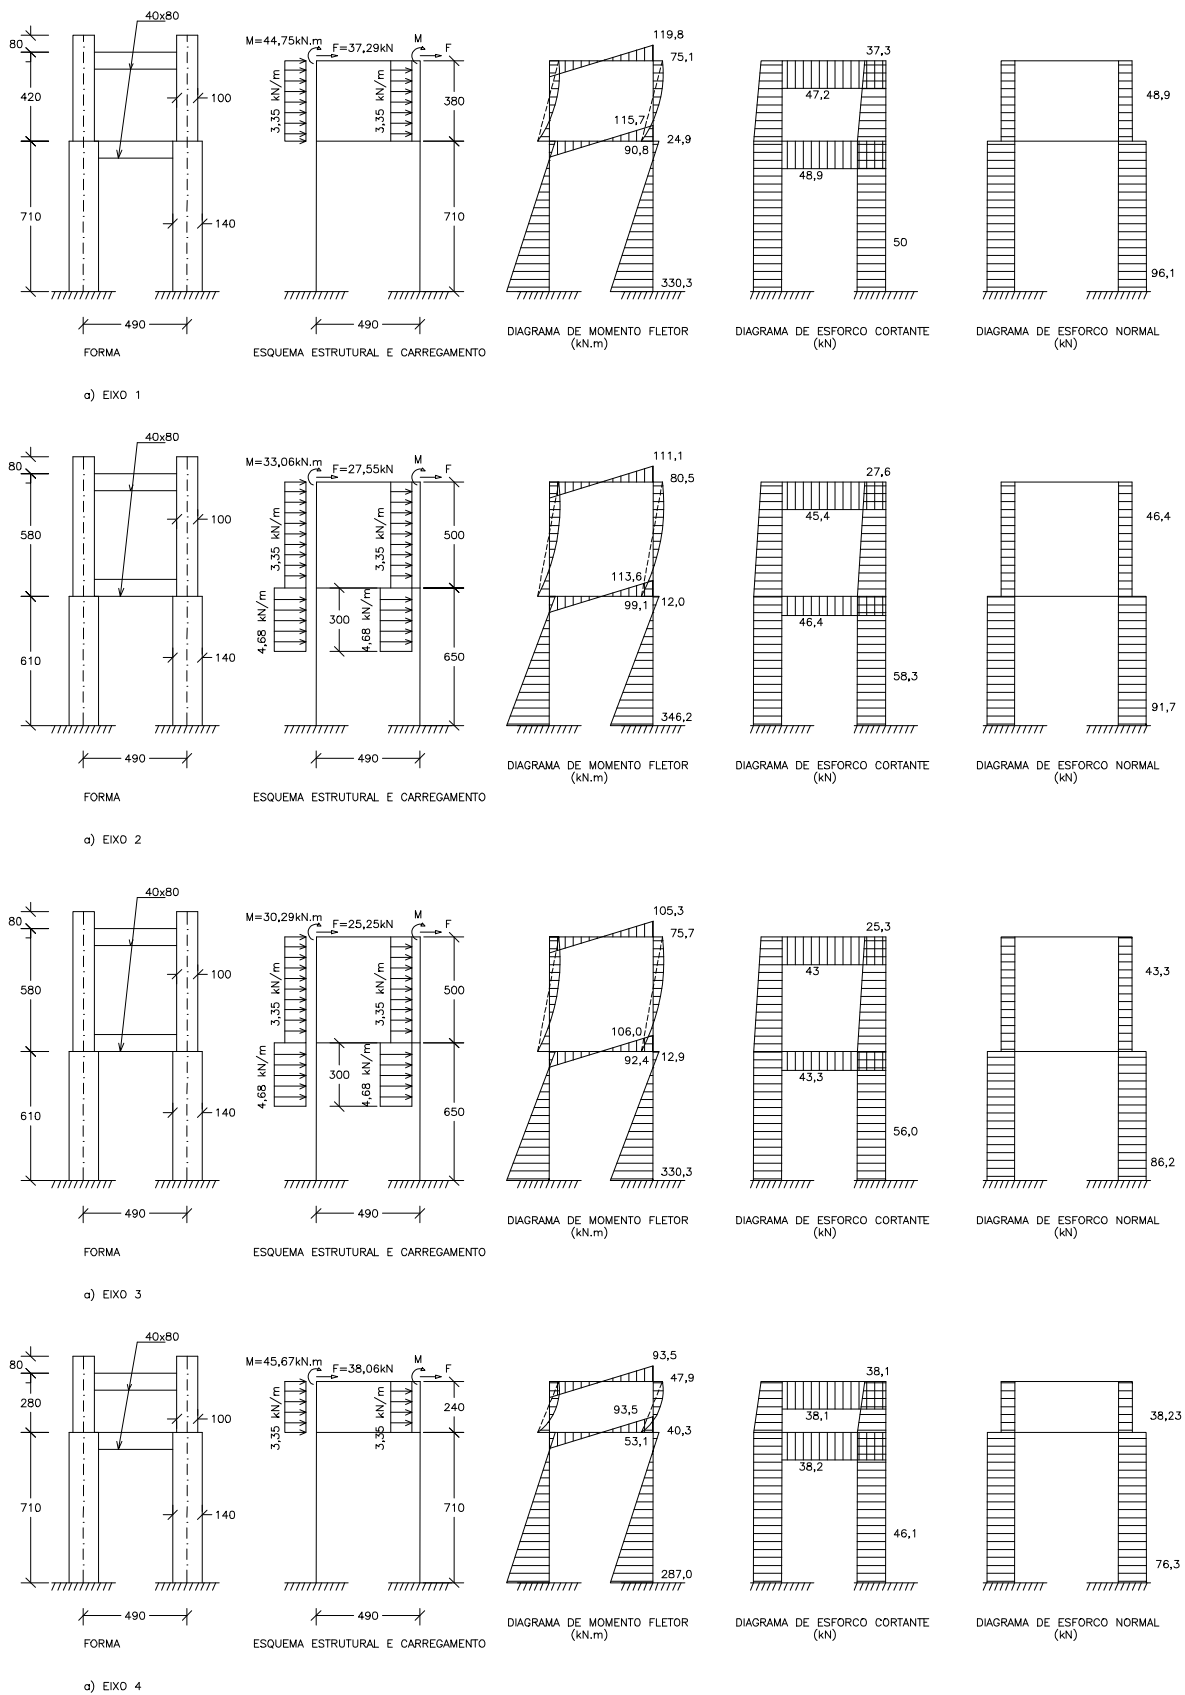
Pórticos transversais da ponte sobre o rio Pau Seco.
